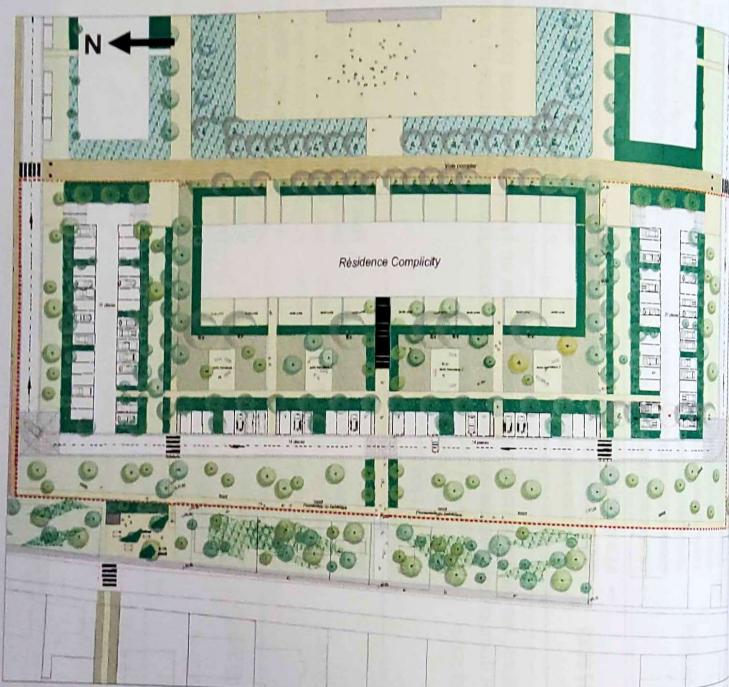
Plan masse du projet d'aménagement (Source : NEXITY - sans échelle
